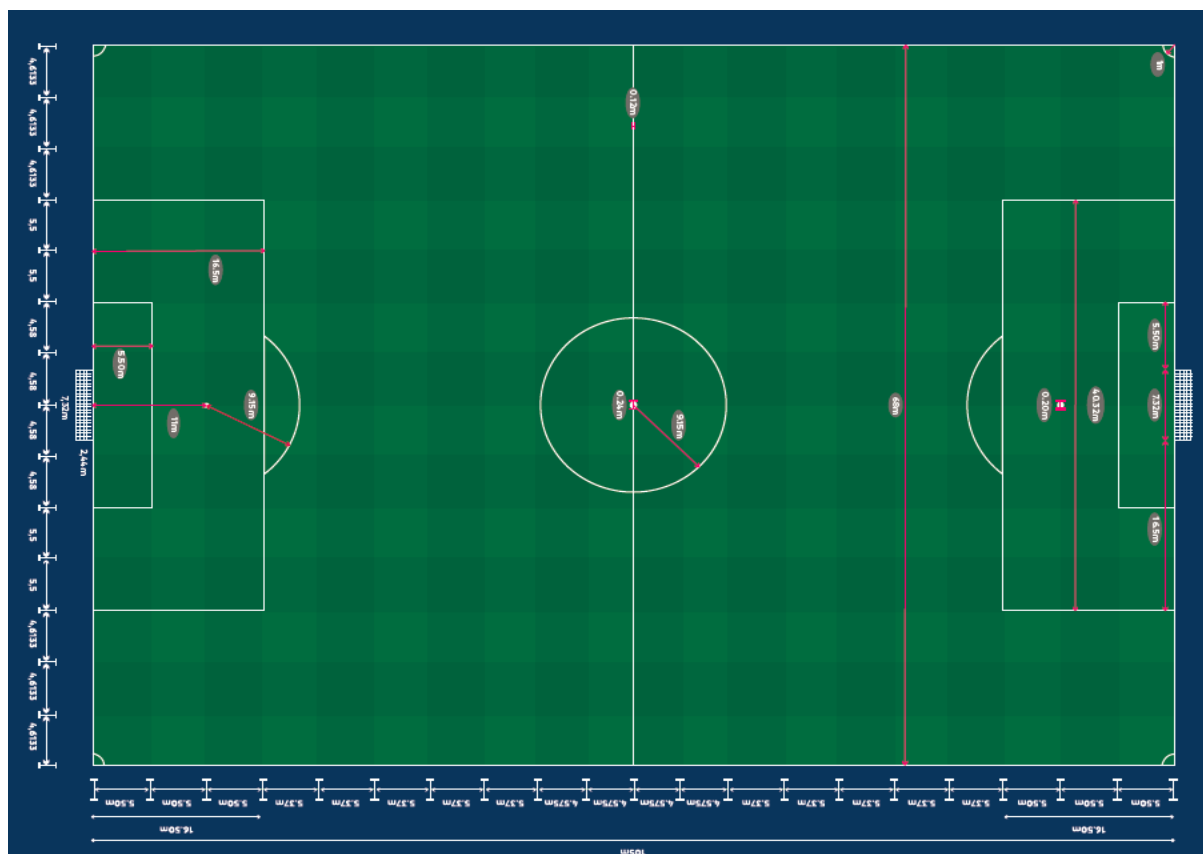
Dimensões do Gramado: 105m de extensão x 68m de largura. O Anexo II contém planta detalhada desta área.
